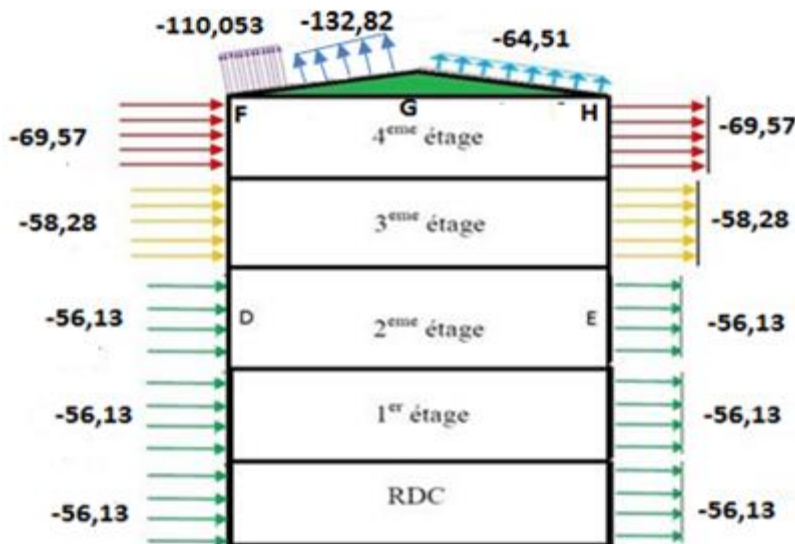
17: Valeurs de pressions $W(z_j)$ sur la construction en direction V2 (pour toiture 3)
